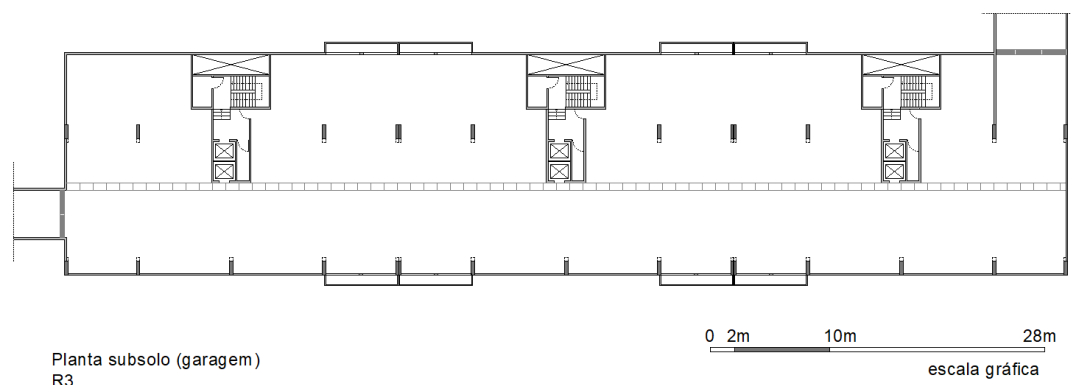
Planta baixa do subsolo do R3. Fonte: da autora, adaptado das pranchas originais do Acervo do Arquiteto Milton Ramos.
